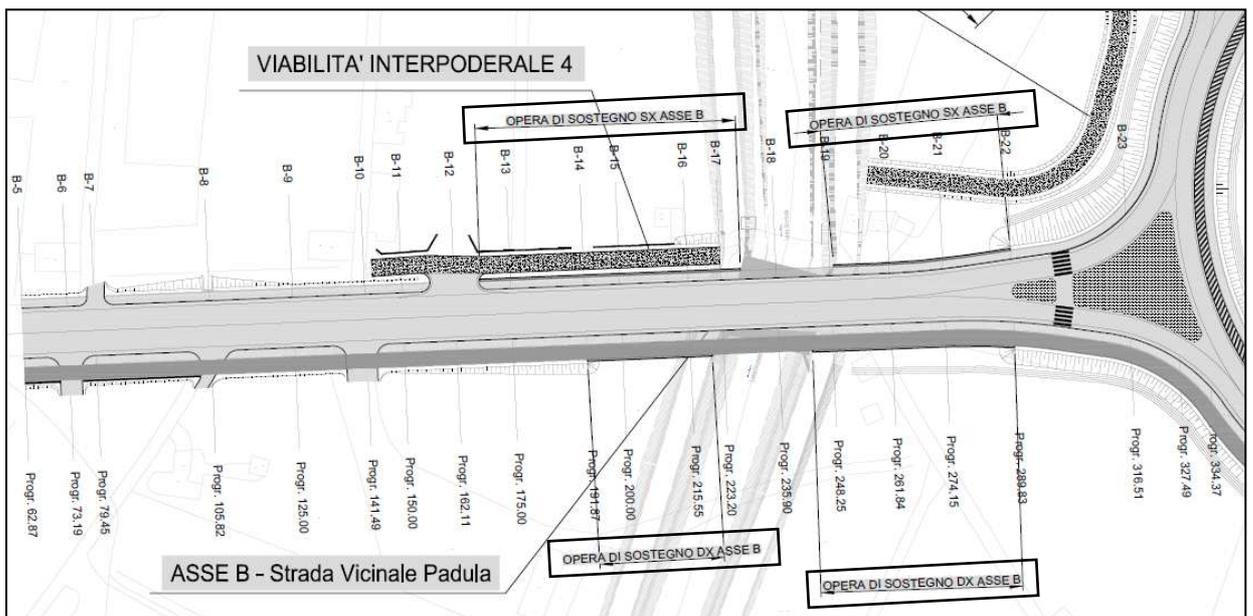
Stralcio planimetrico dell'asse B con individuazione delle opere di sostegno.
